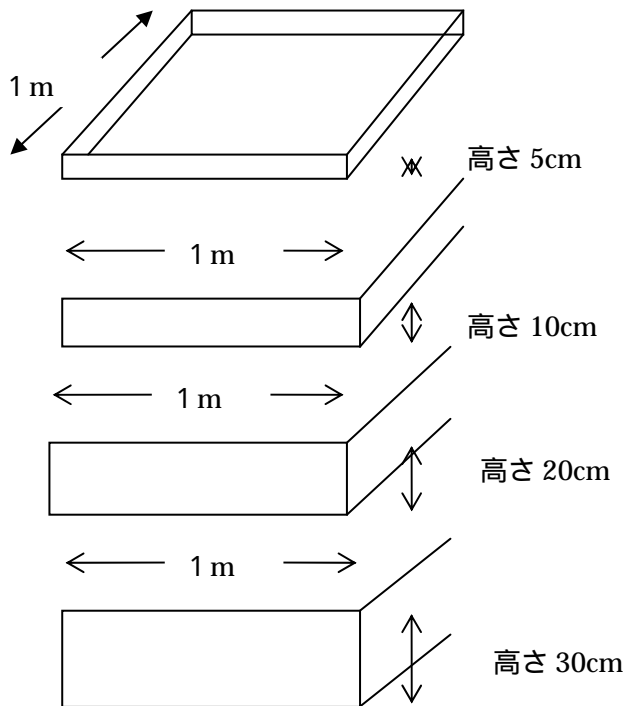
平成 17 年度土壤浸食対策工試験施工の配置模式図
